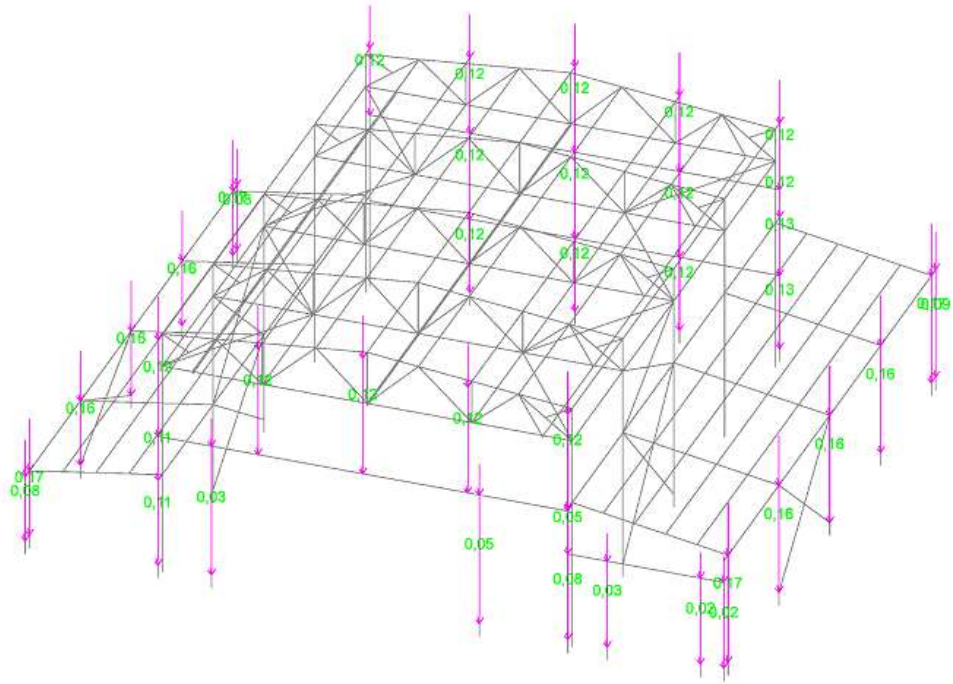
Схема загрузки постоянной нагрузкой от собственного веса стеновых панелей
